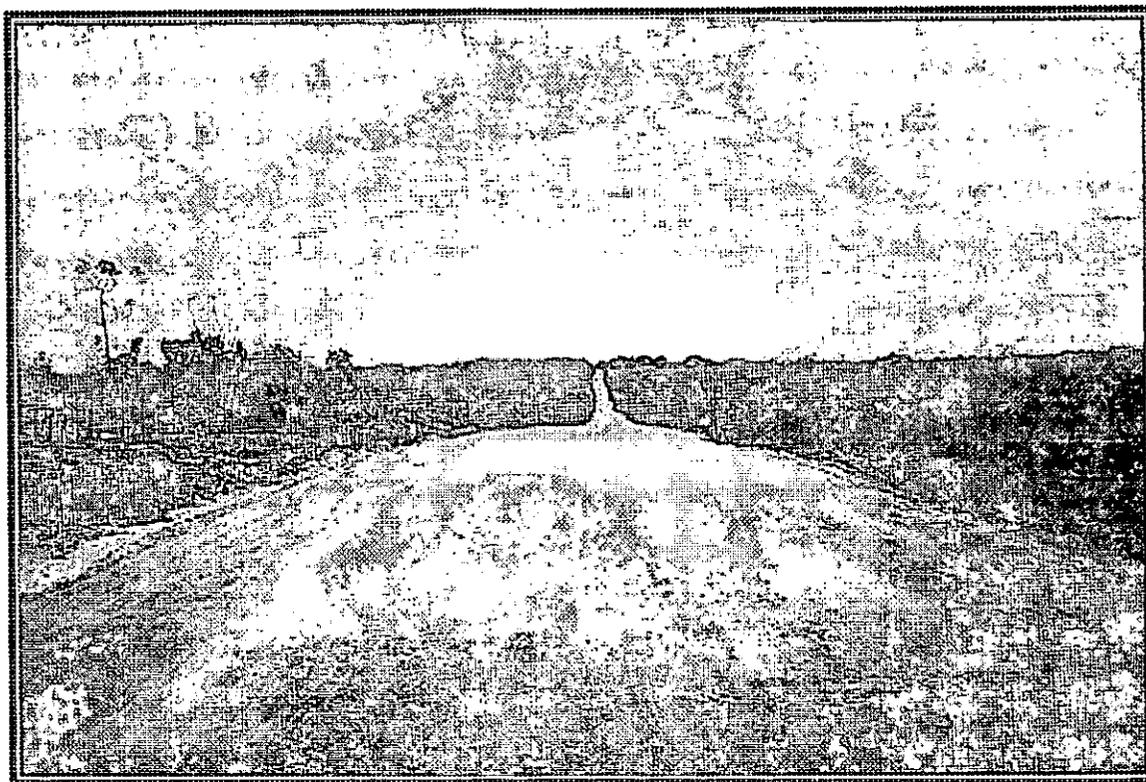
LOCAL DO EIXO DA BARRAGEM
